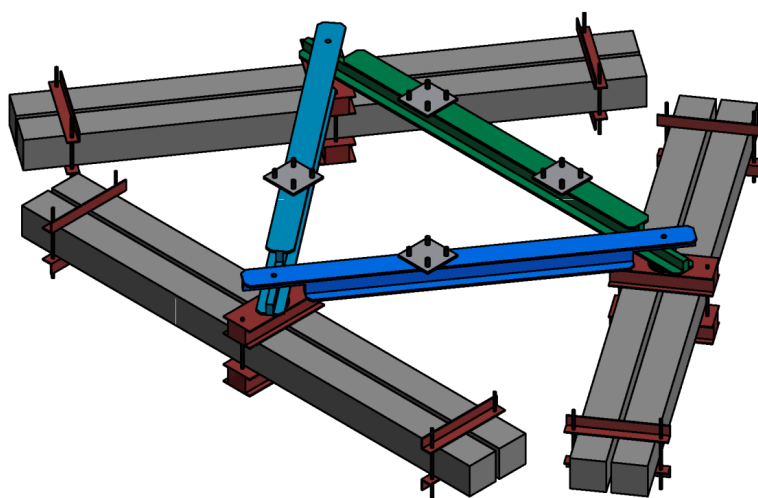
Поверхностный фундамент ФП1800-6х6,
